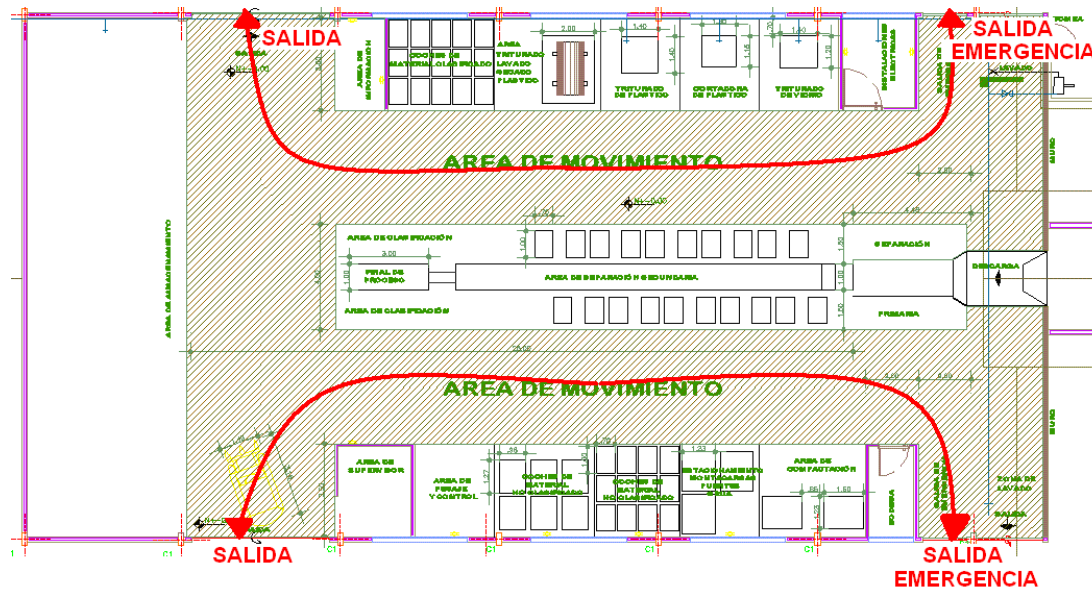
Vista arquitectónica de áreas de movimiento y salidas en la planta de reciclaje
